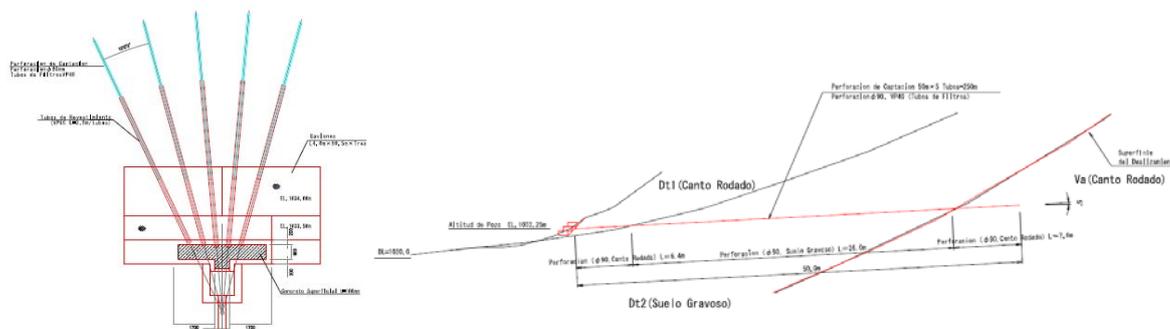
Diagrama estructural del trabajo de perforación de drenaje horizontal en la zona de El Berrinche (Fuente: Planos as-built)
